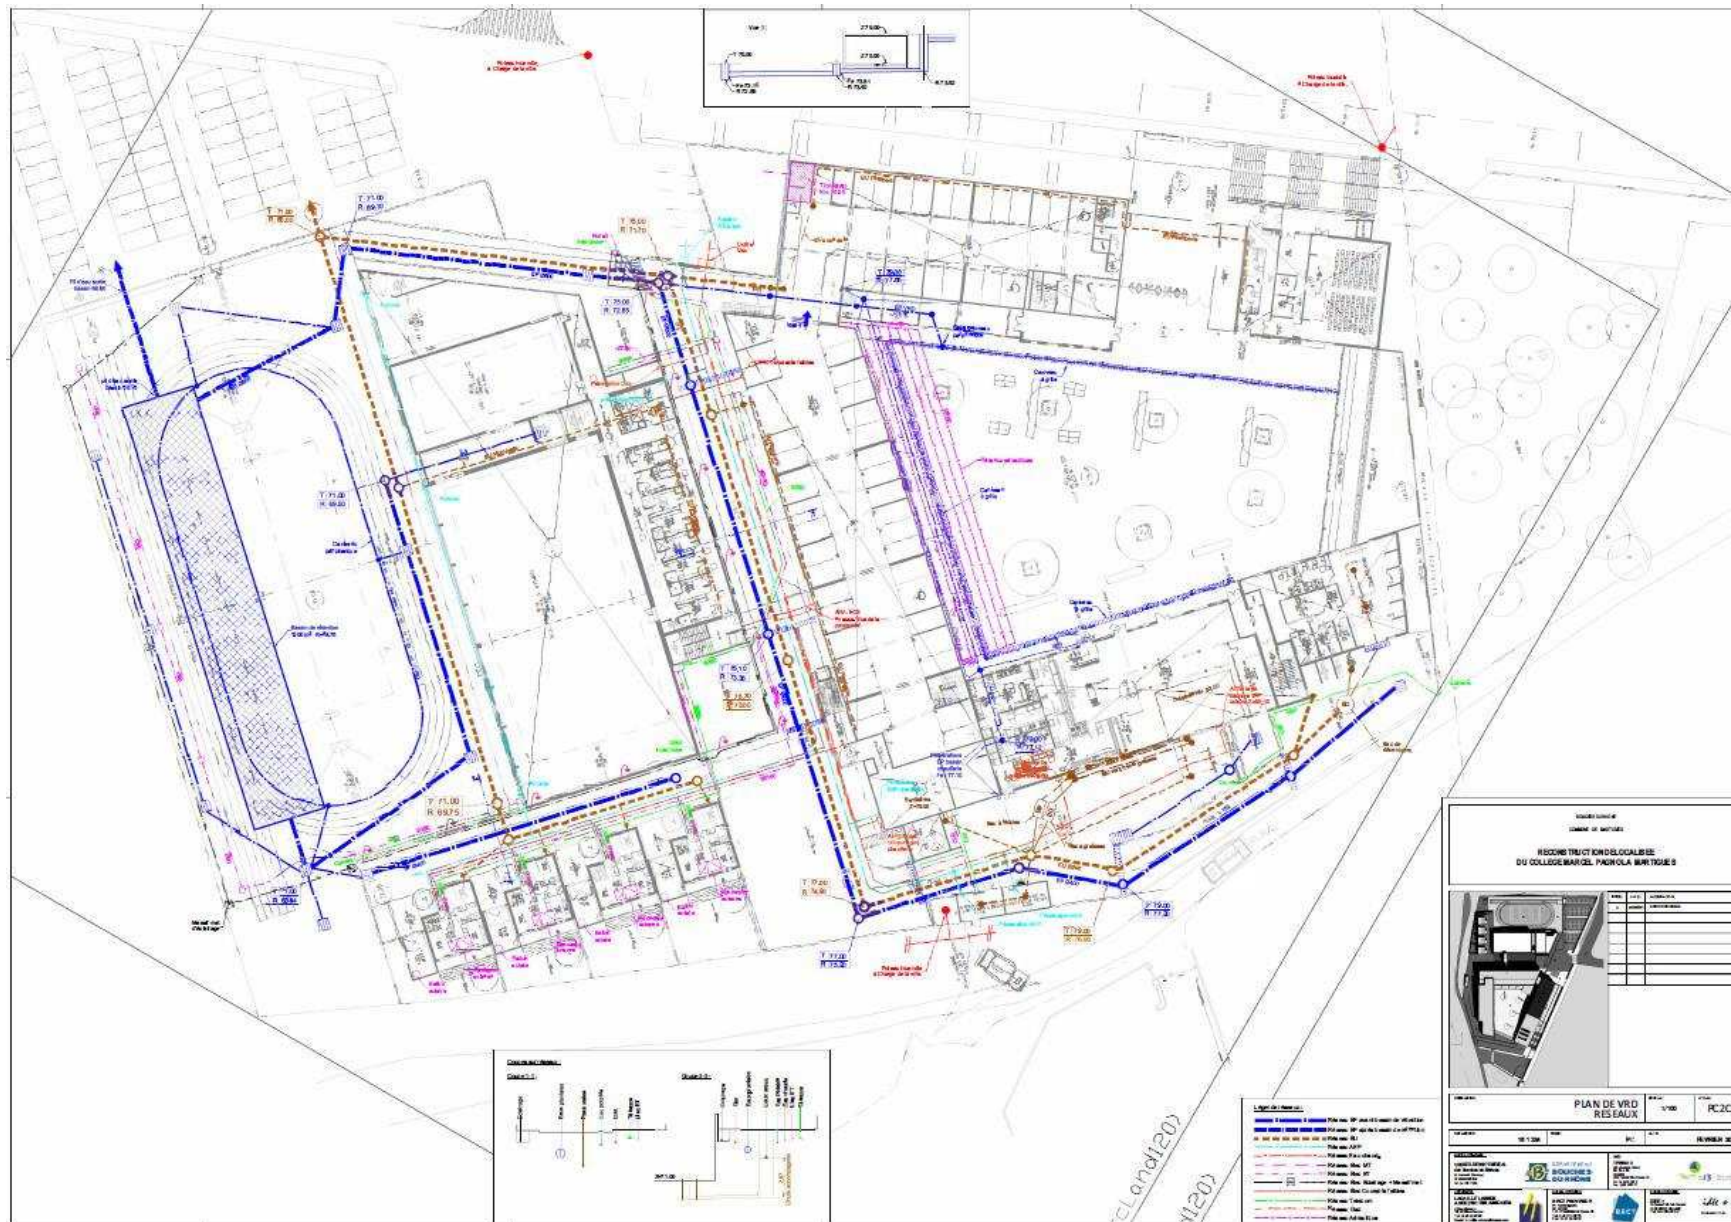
Plan des réseaux détaillé au sein du futur collège
